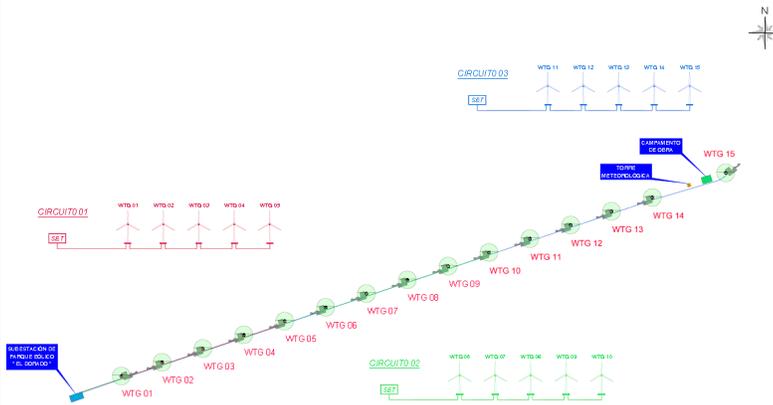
Vista en Planta - Parque Eólico El Dorado
